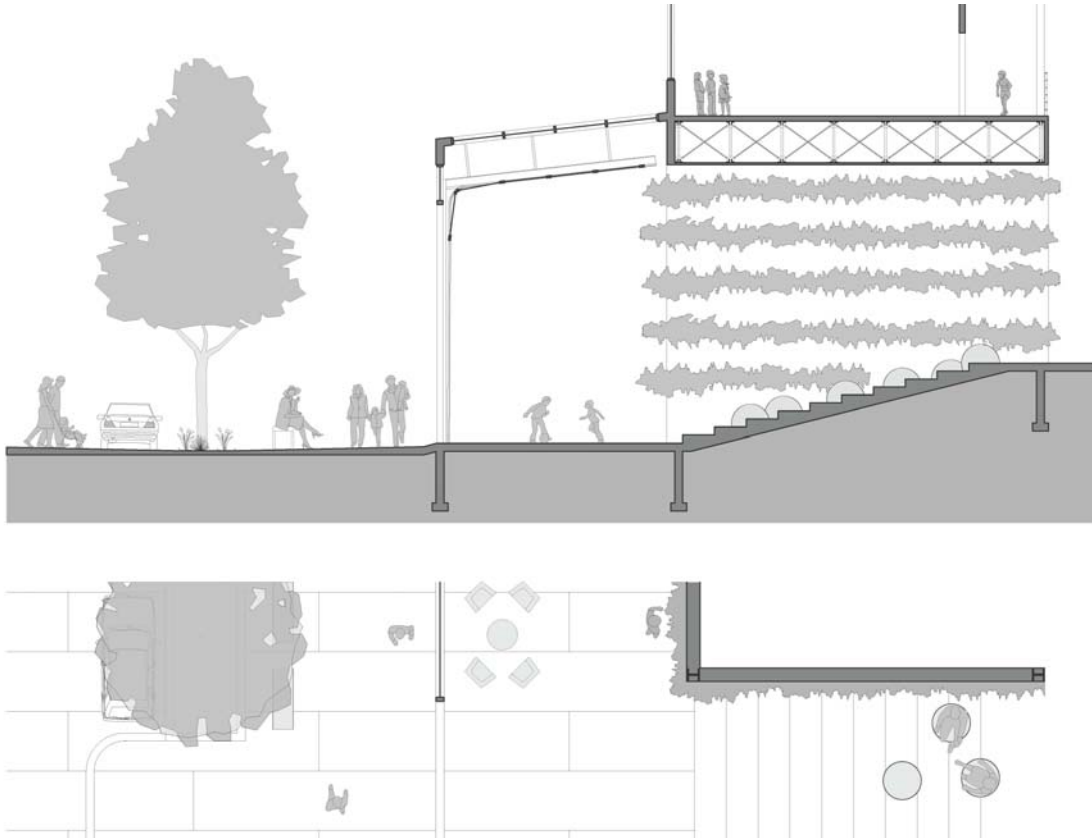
Plan et coupe d'une proposition d'aménagement pour un espace public extérieur reliant un marché et une serre, projet de Marc-Antoine Bourbeau.
